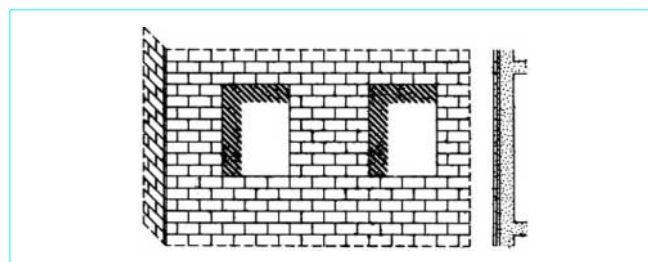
Revêtement scellé en plein (appareillage en format 40 x 20 cm)
